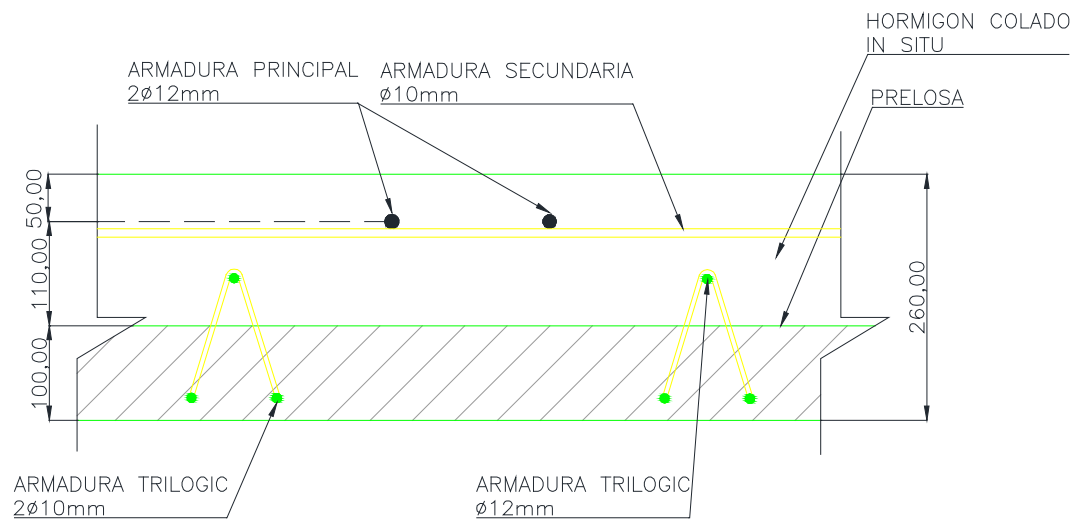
Esquema final de armaduras en apoyo (fuente: elaboración propia).
